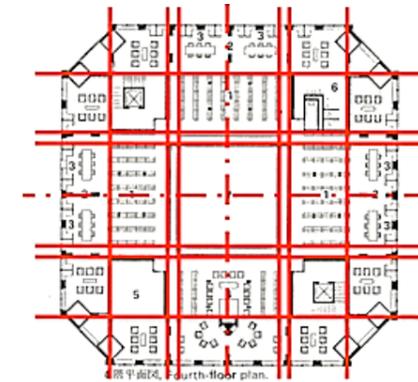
Planta esquemática estructural de la biblioteca Exeter.
